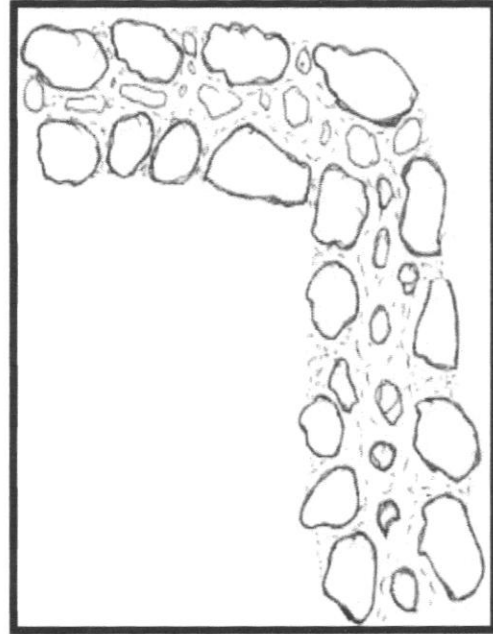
Appairage d'un mur en pierre à Adjahil
